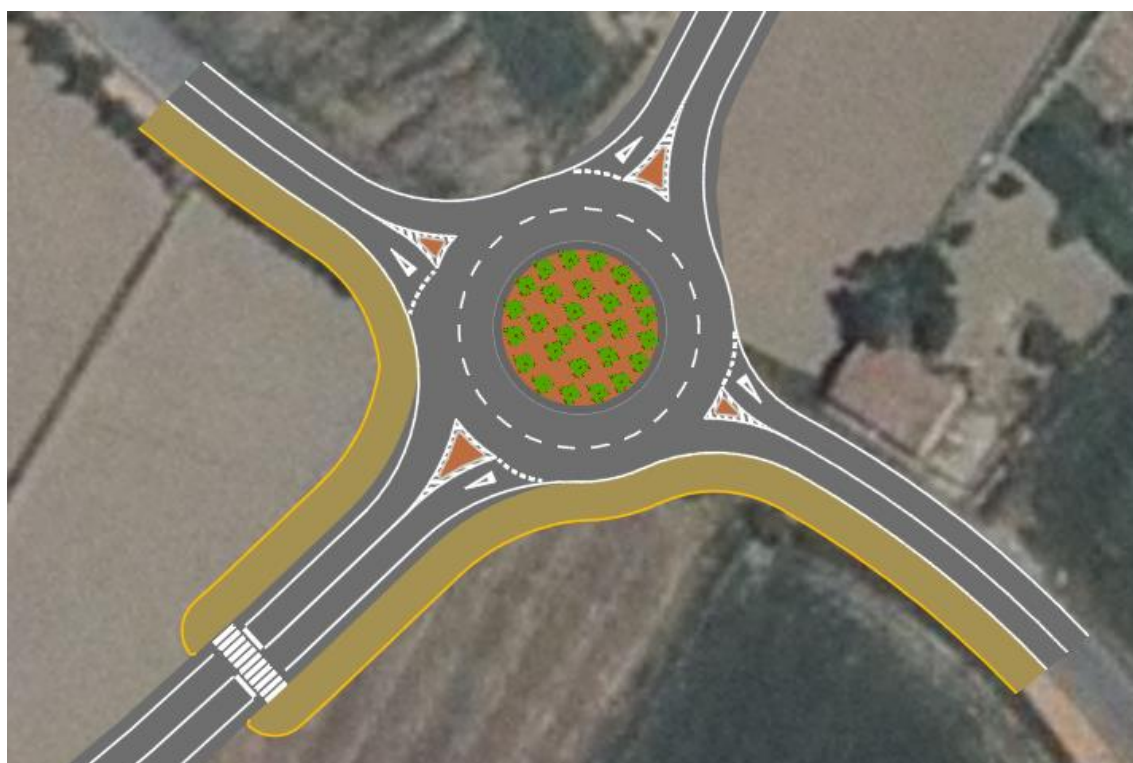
Planta de la rotonda de enlace entre la vía proyectada y la carretera GR-3311.
